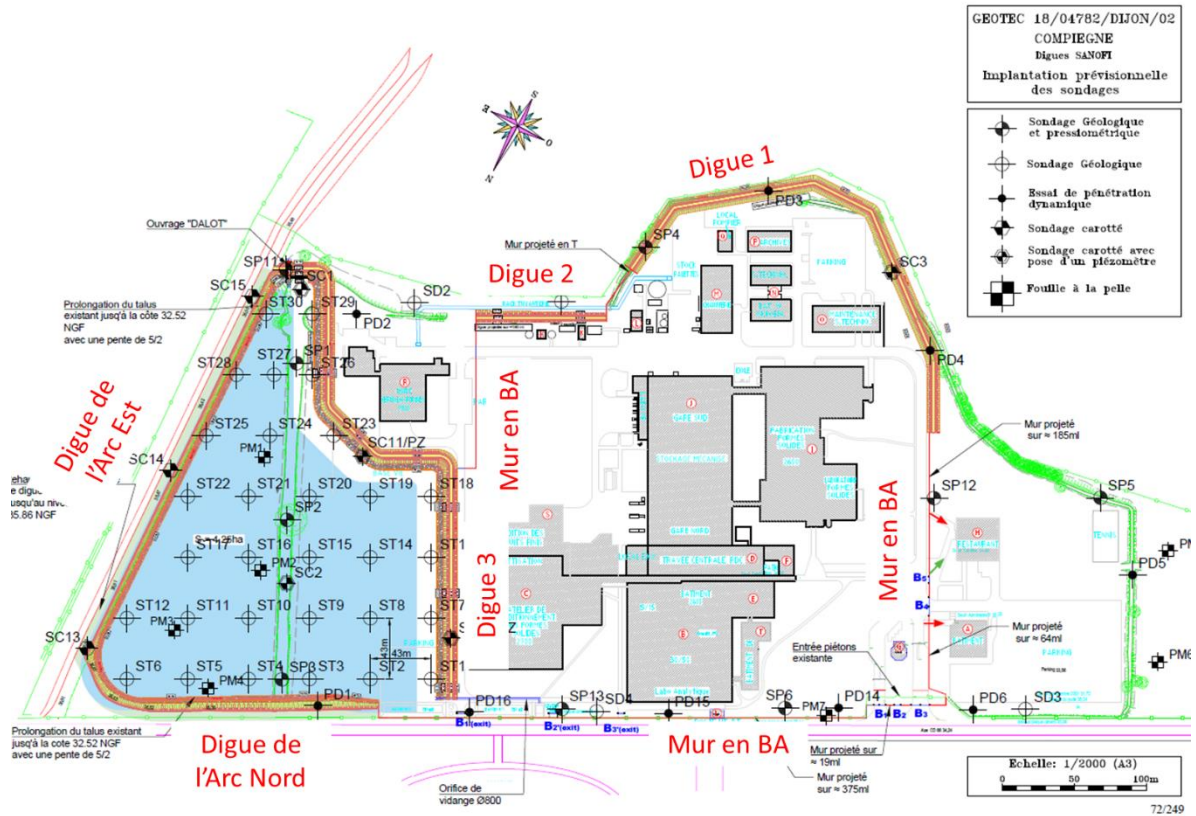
Plan d'implantation des sondages géotechniques (investigation 2021)
